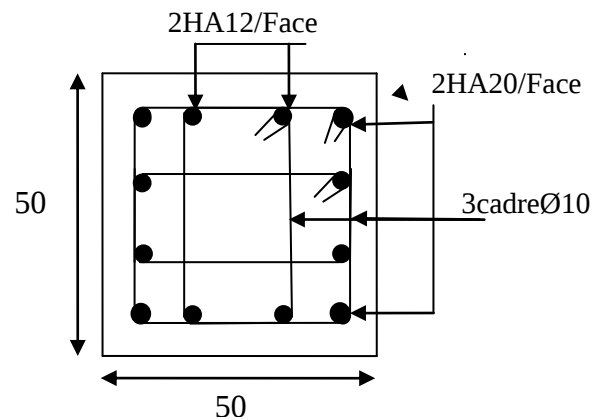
schéma de ferrailage des poteaux étage 2,3, et 4
